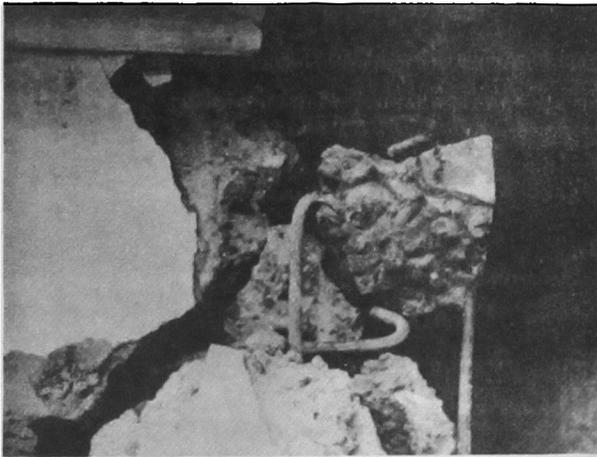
Grieta diagonal en conexión de pilar con viga. Calle Beaucheff. Valdivia.
